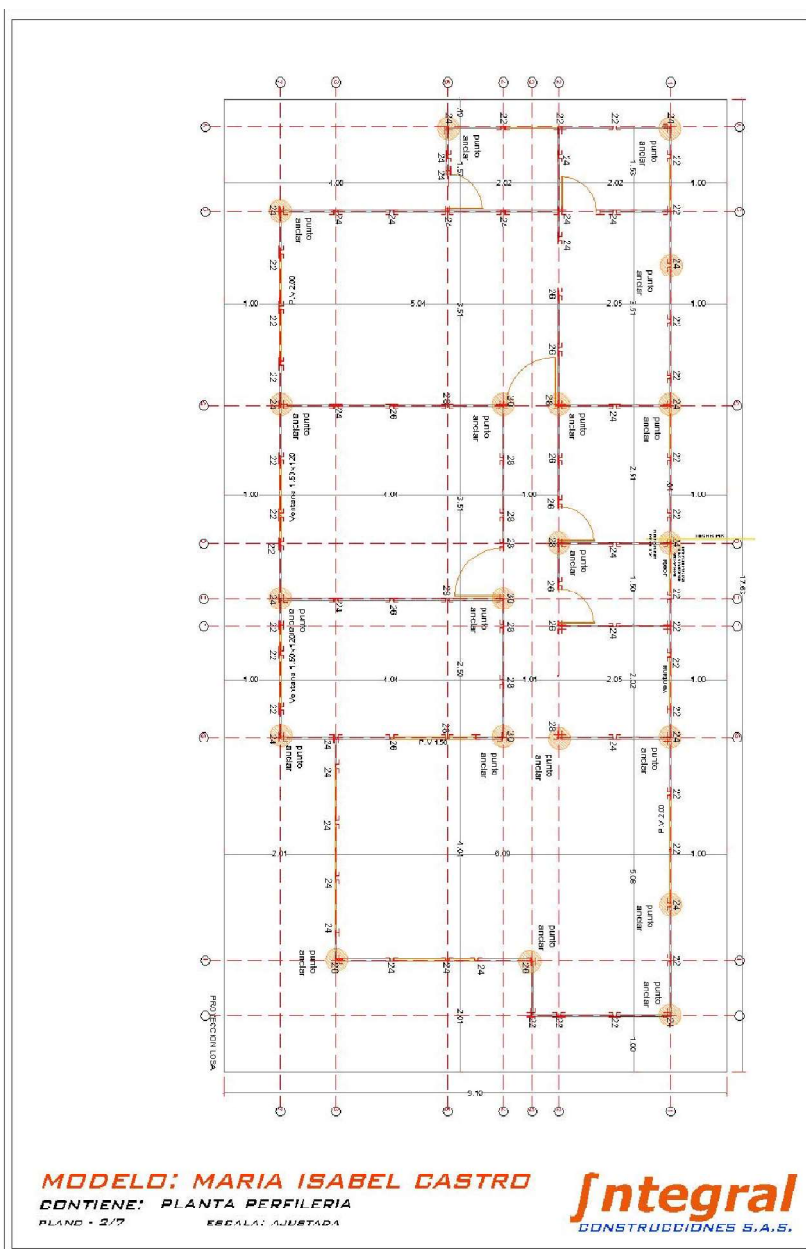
Plano arquitectónico vivienda María Isabel Castro
